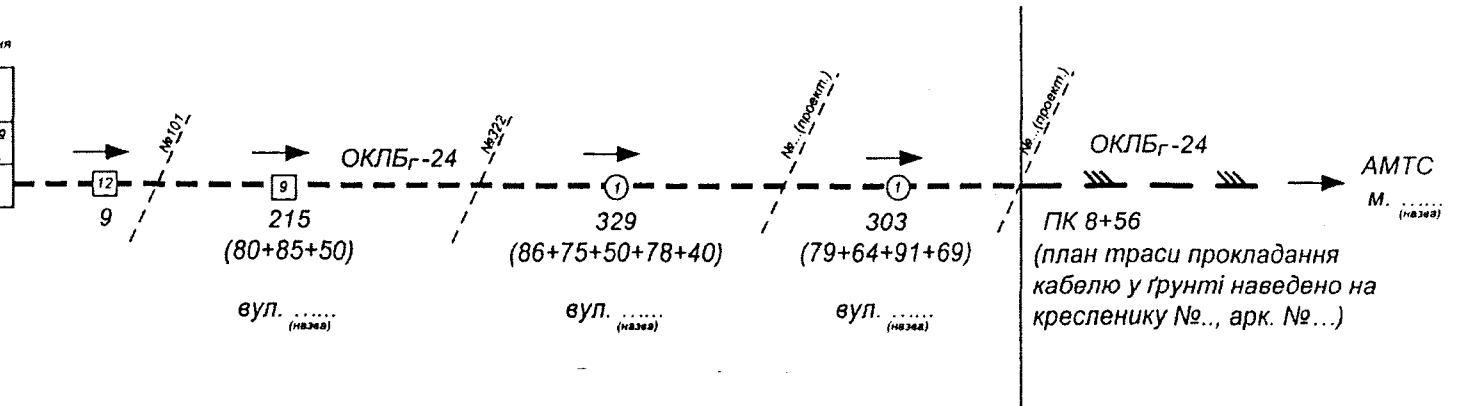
План траси будівництва (докладання) кабельної каналізації
